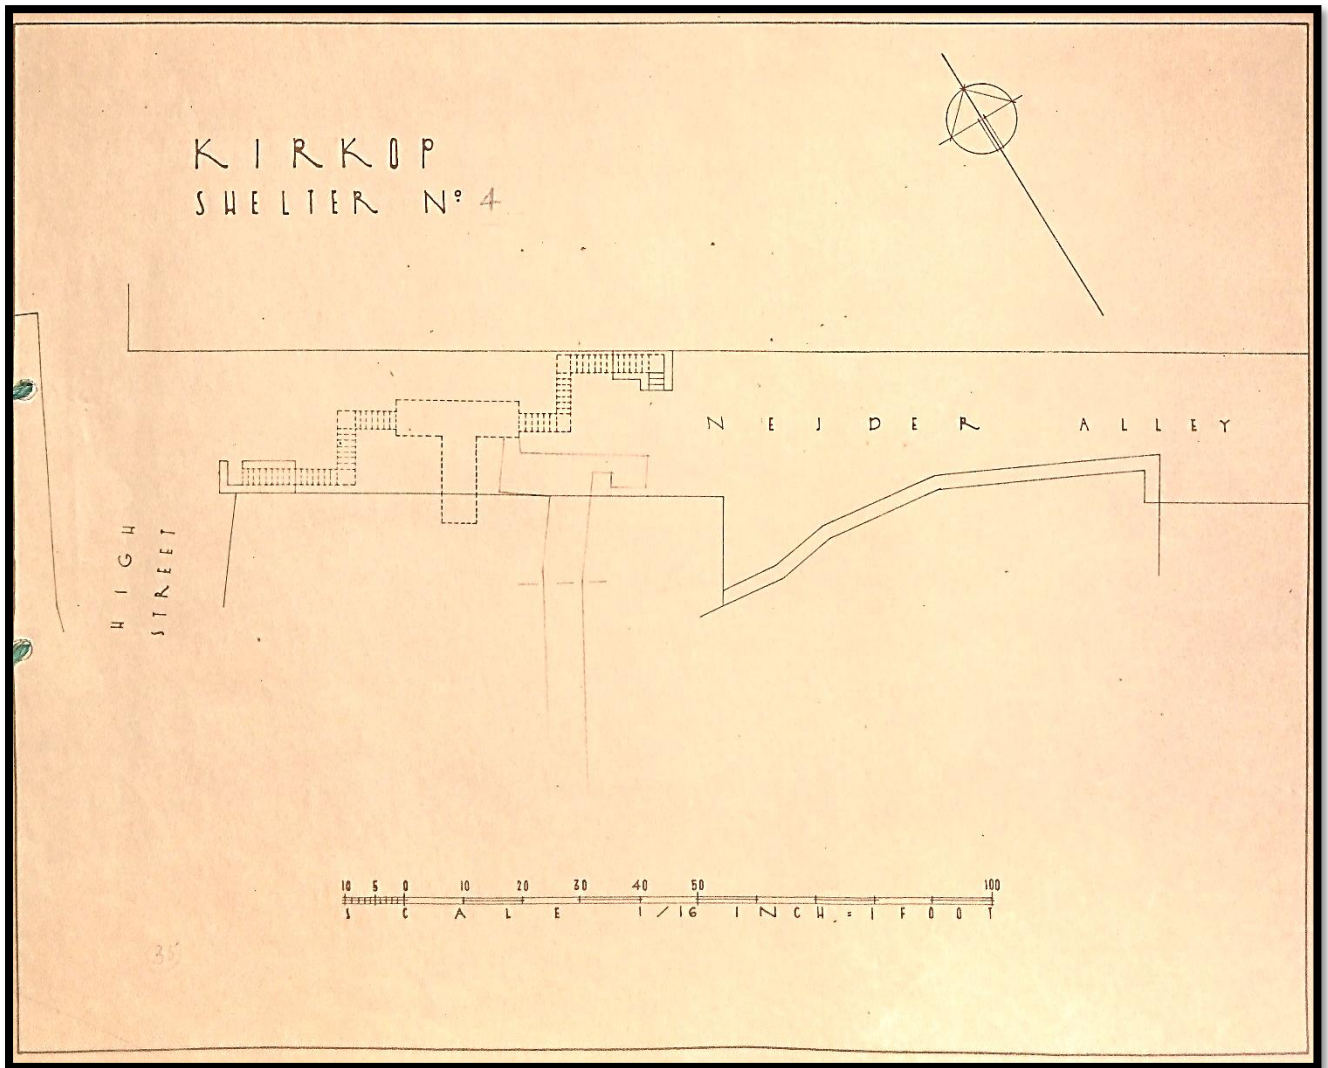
Planta do Abrigo nº4 "High Street – Nejder Alley."
